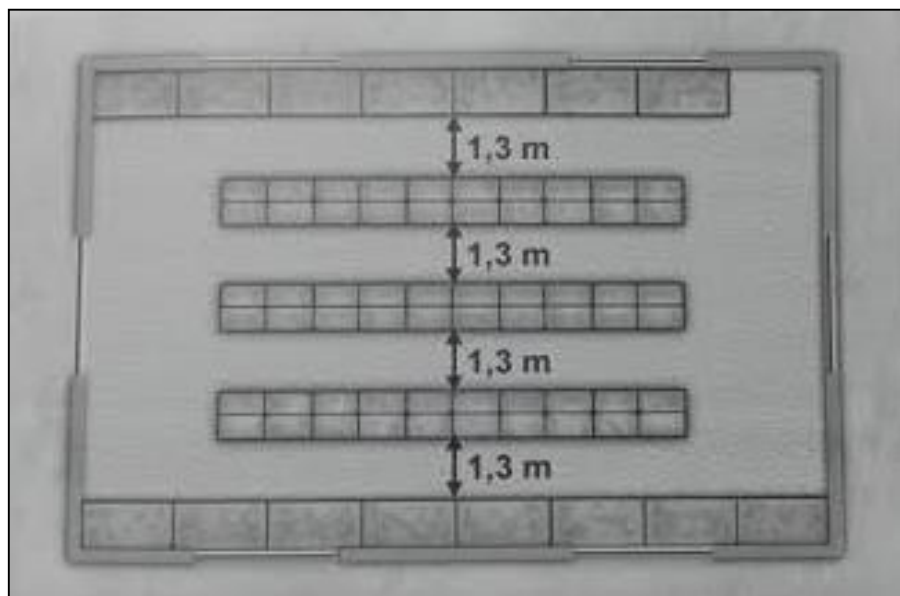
Planta baixa de organização de aquários e tanques sugerido por VIDAL Jr. (2007)
